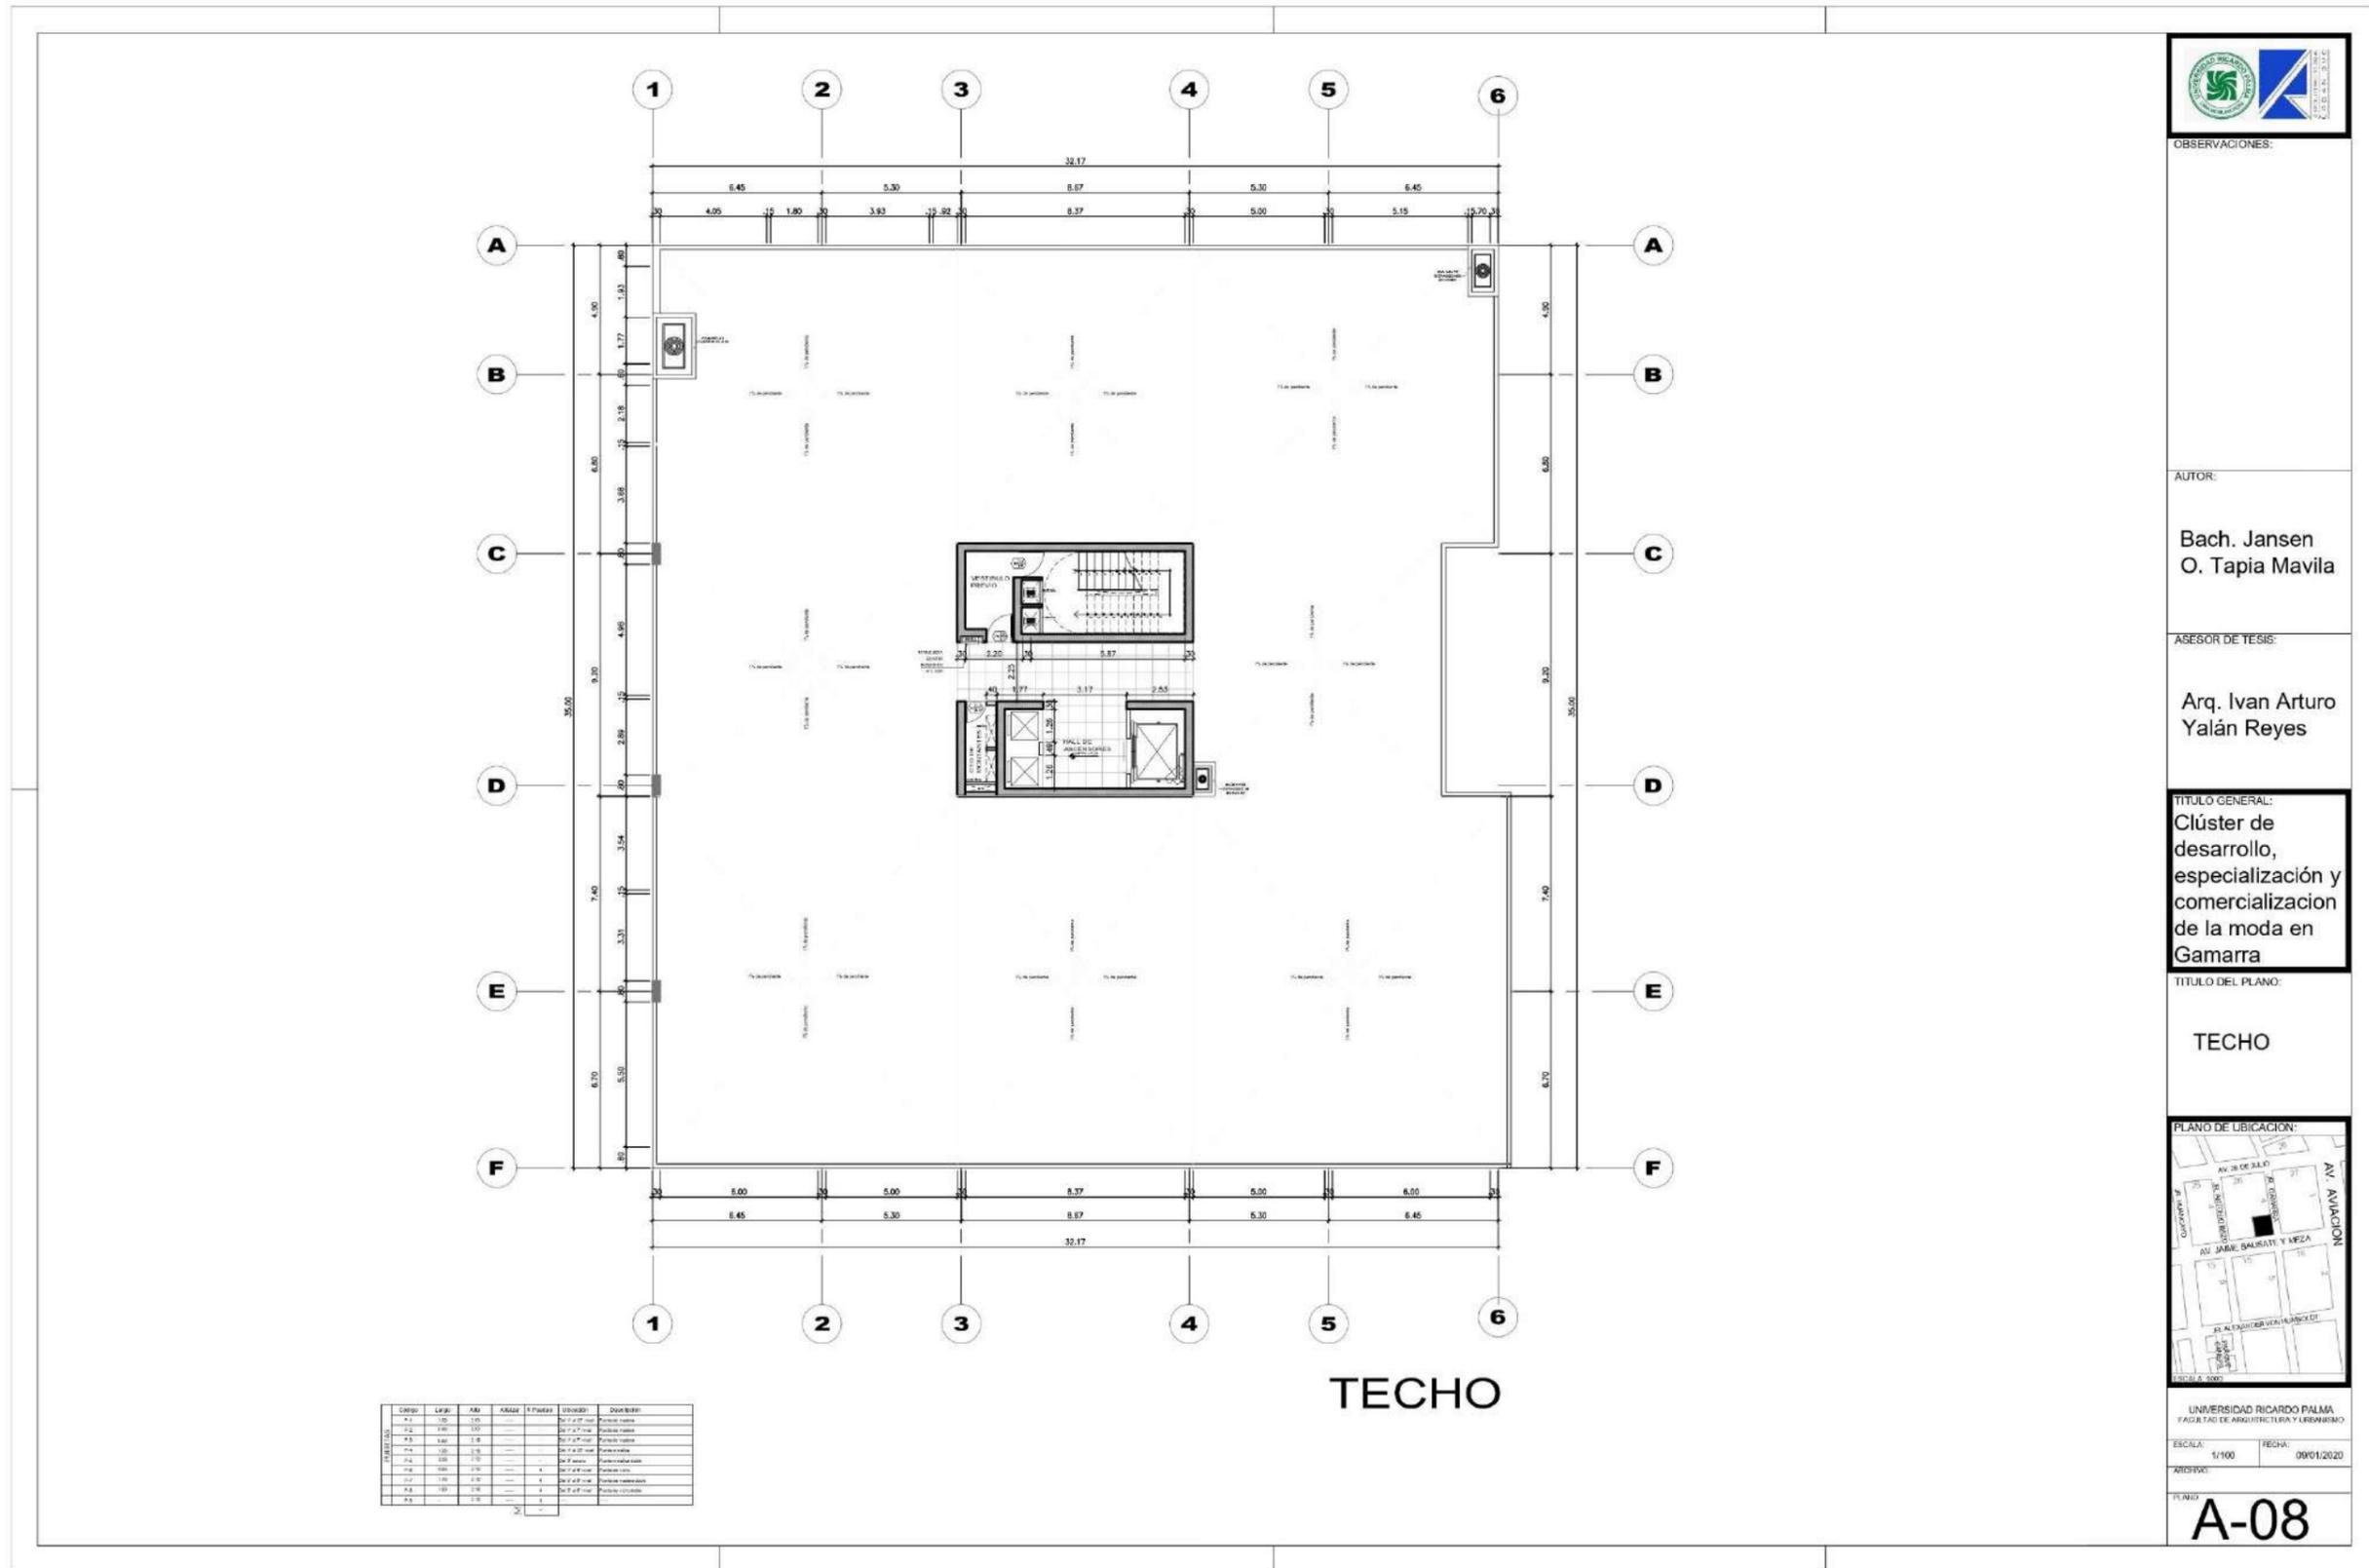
Planimetría de techos (Fuente: Elaboración Propia)
